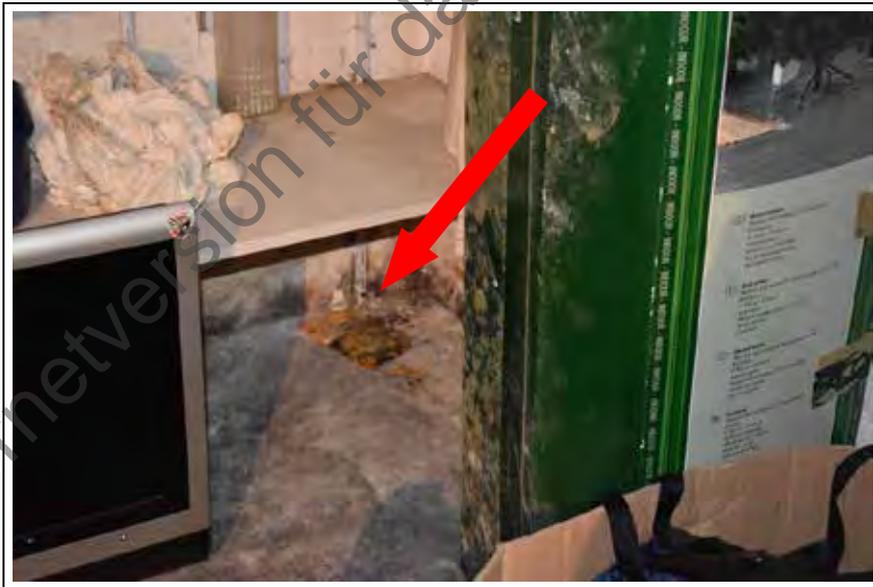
Wohnhaus, KG, Kellerraum mit Feuchtigkeitsschäden
